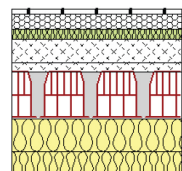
Sezione verticale (A-A, secondo l'indicazione nelle piante) della casa passiva di Carpi.
